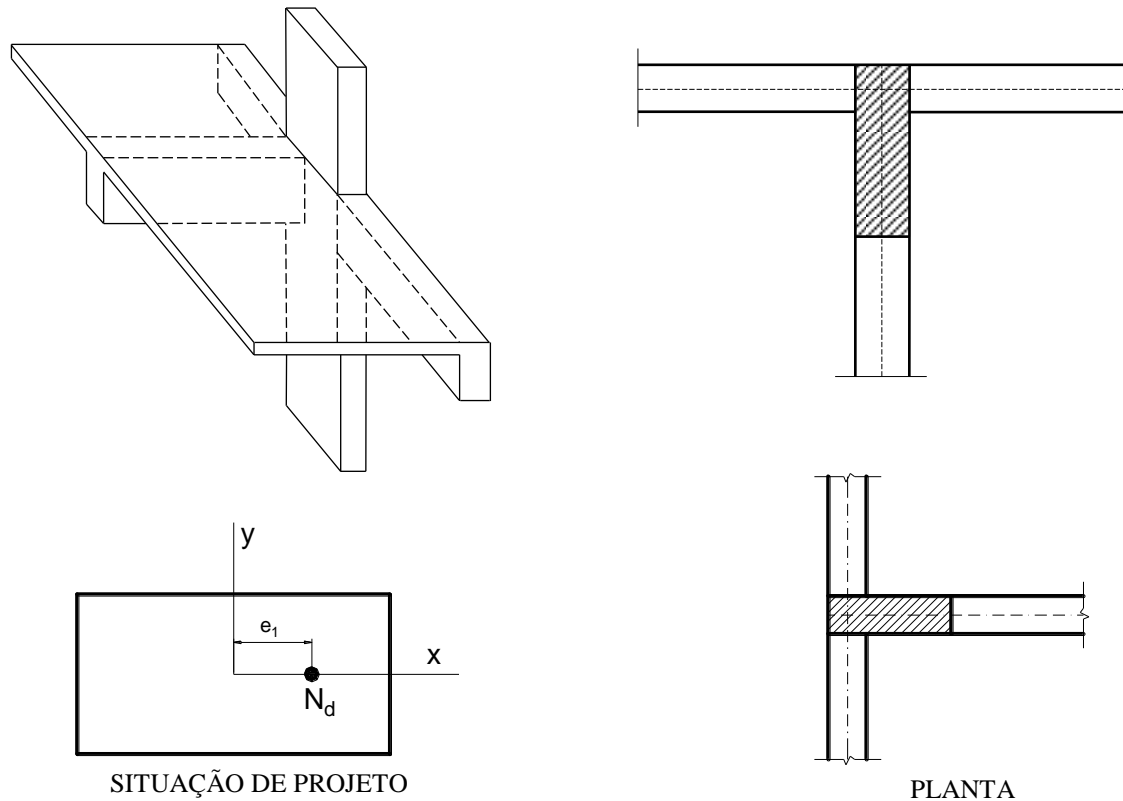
Arranjo do pilar de extremidade na estrutura real, em planta e situação de projeto.
